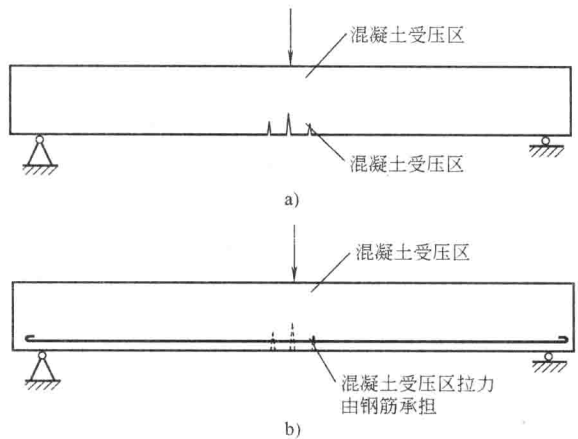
素混凝土梁和钢筋混凝土梁受力破坏示意图
